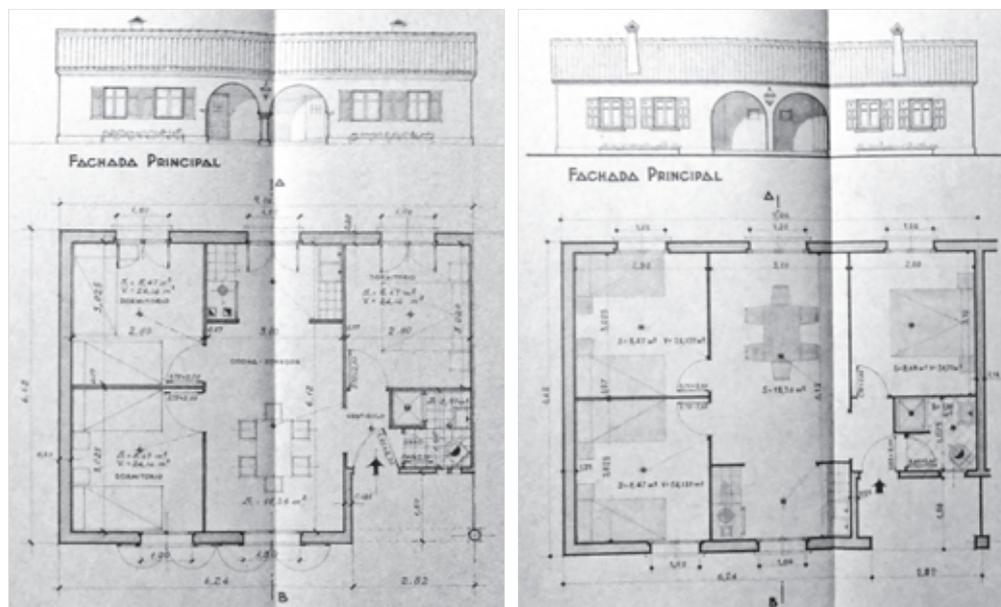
Detalles de los planos de los tipos de vivienda A (izquierda) y B (derecha) del Grupo Yagüe de viviendas ultrabaratadas en Briviesca, agosto de 1947. Fuente: ACFomJCyL, caja 157
